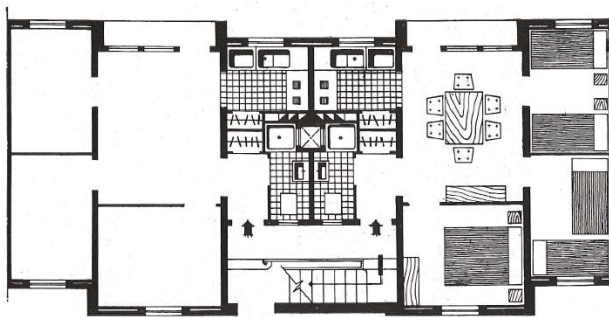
Obra Sindical del Hogar. *Planta tipo de viviendas de renta mínima del grupo "magdalena" en Castellón de la Plana, 1956*. Fuente: "Grupo 'Magdalena', 160 viviendas en Castellón de la Plana". *Hogar y Arquitectura* 4 (1956): 18-21.
